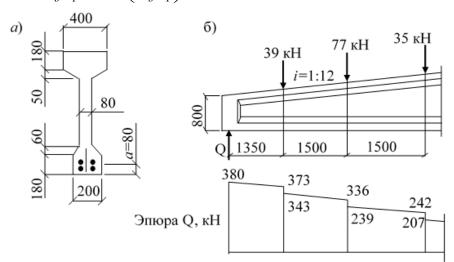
Сечение, нагрузки и размеры двухскатной балки
